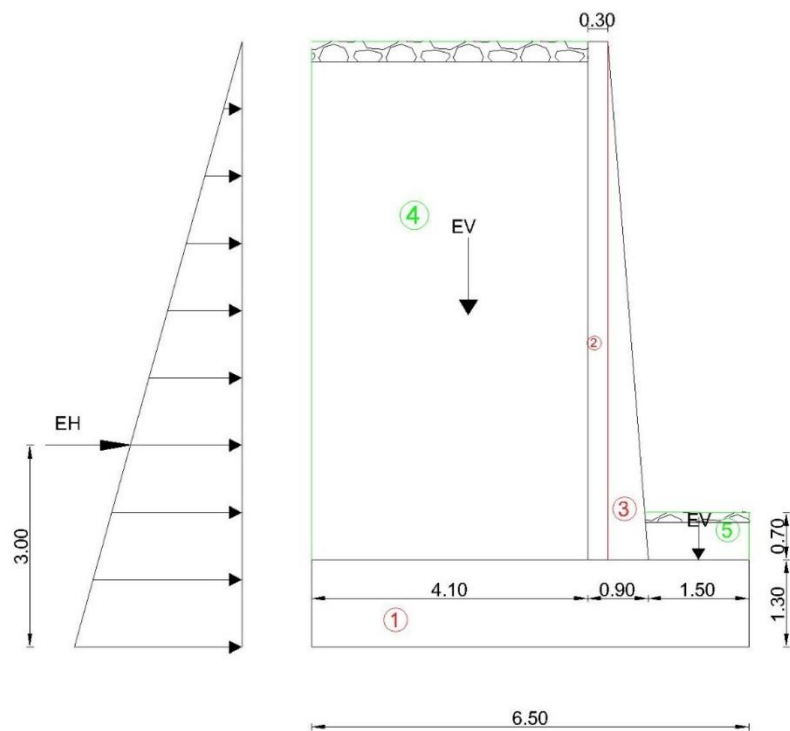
84: Cargas verticales y horizontales (Fuente: Elaboración propia)
